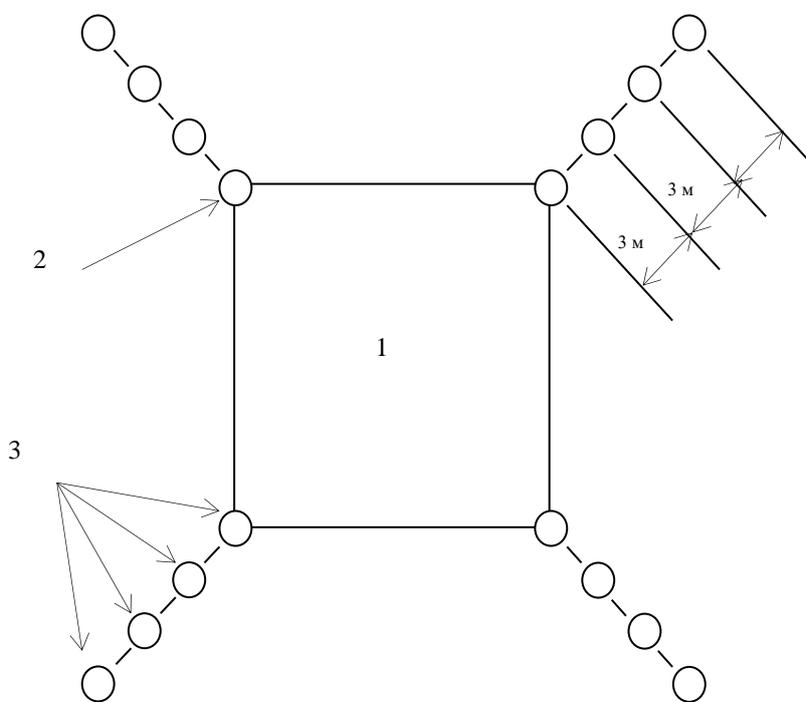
Общая схема взлетно-посадочной площадки: 1 — рабочая площадь посадочной площадки; 2 — усеченный конус или призма; 3 — флажки-ориентиры, или дорожный сигнальный конус, или автопокрышки
